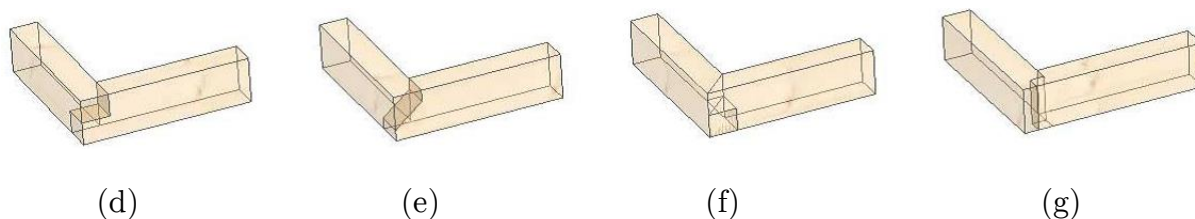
Překlátované spoje, dělení podle hloubky zářezů:
